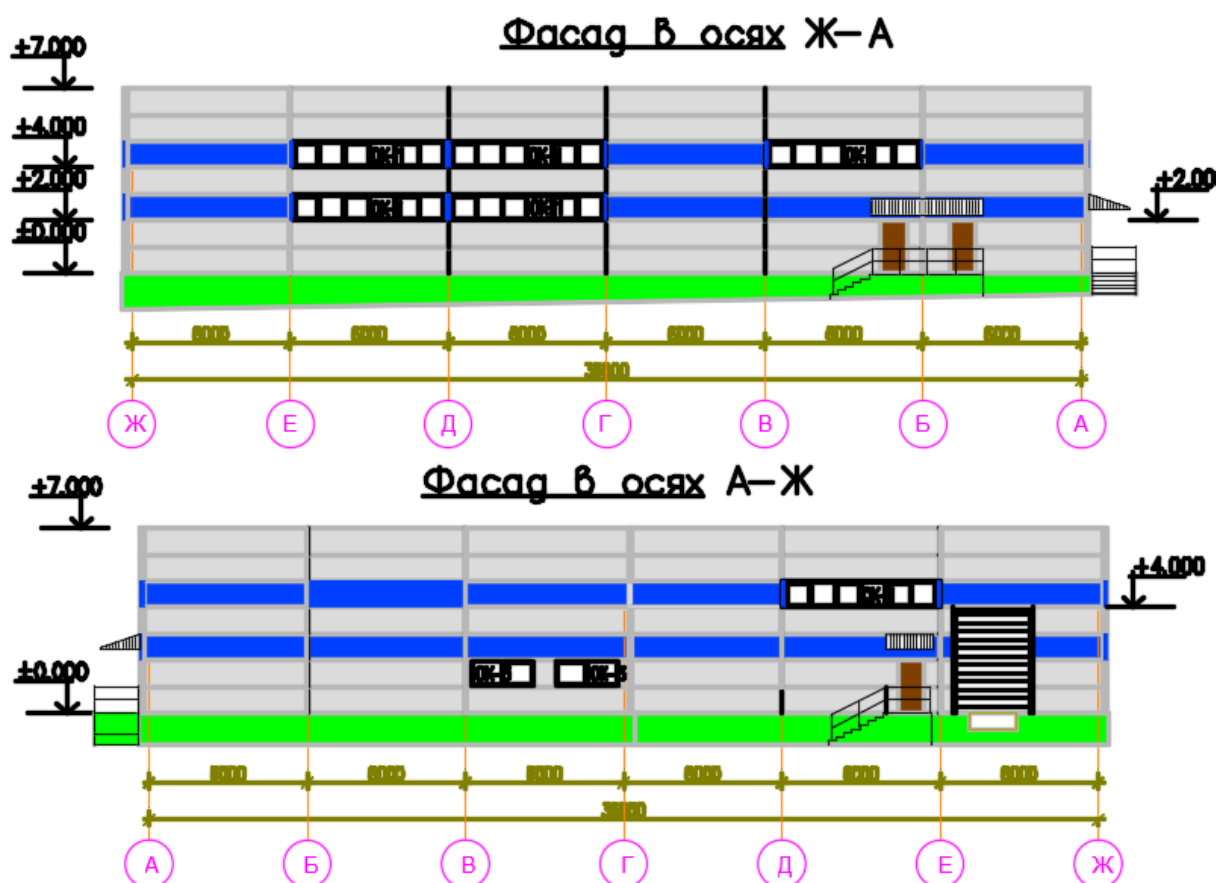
Схема раскладки панелей на одноэтажном здании: продольные (в разрезе), торцевые (фасады)
